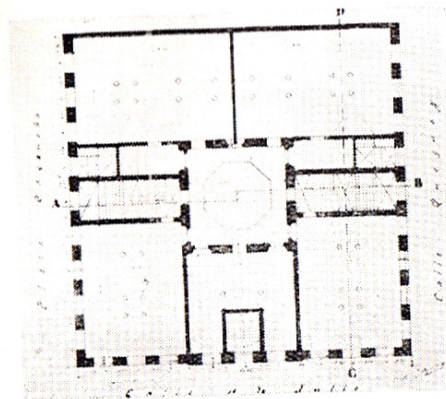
Palacio Heber-Jackson — Planta bajo.
